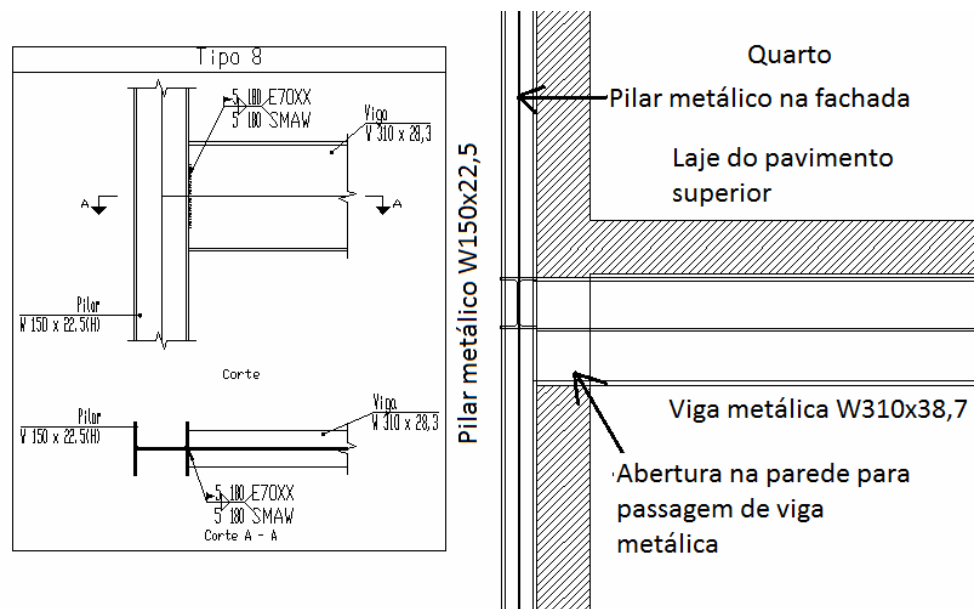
FURO NA ALVENARIA PARA PASSAGEM DA VIGA
